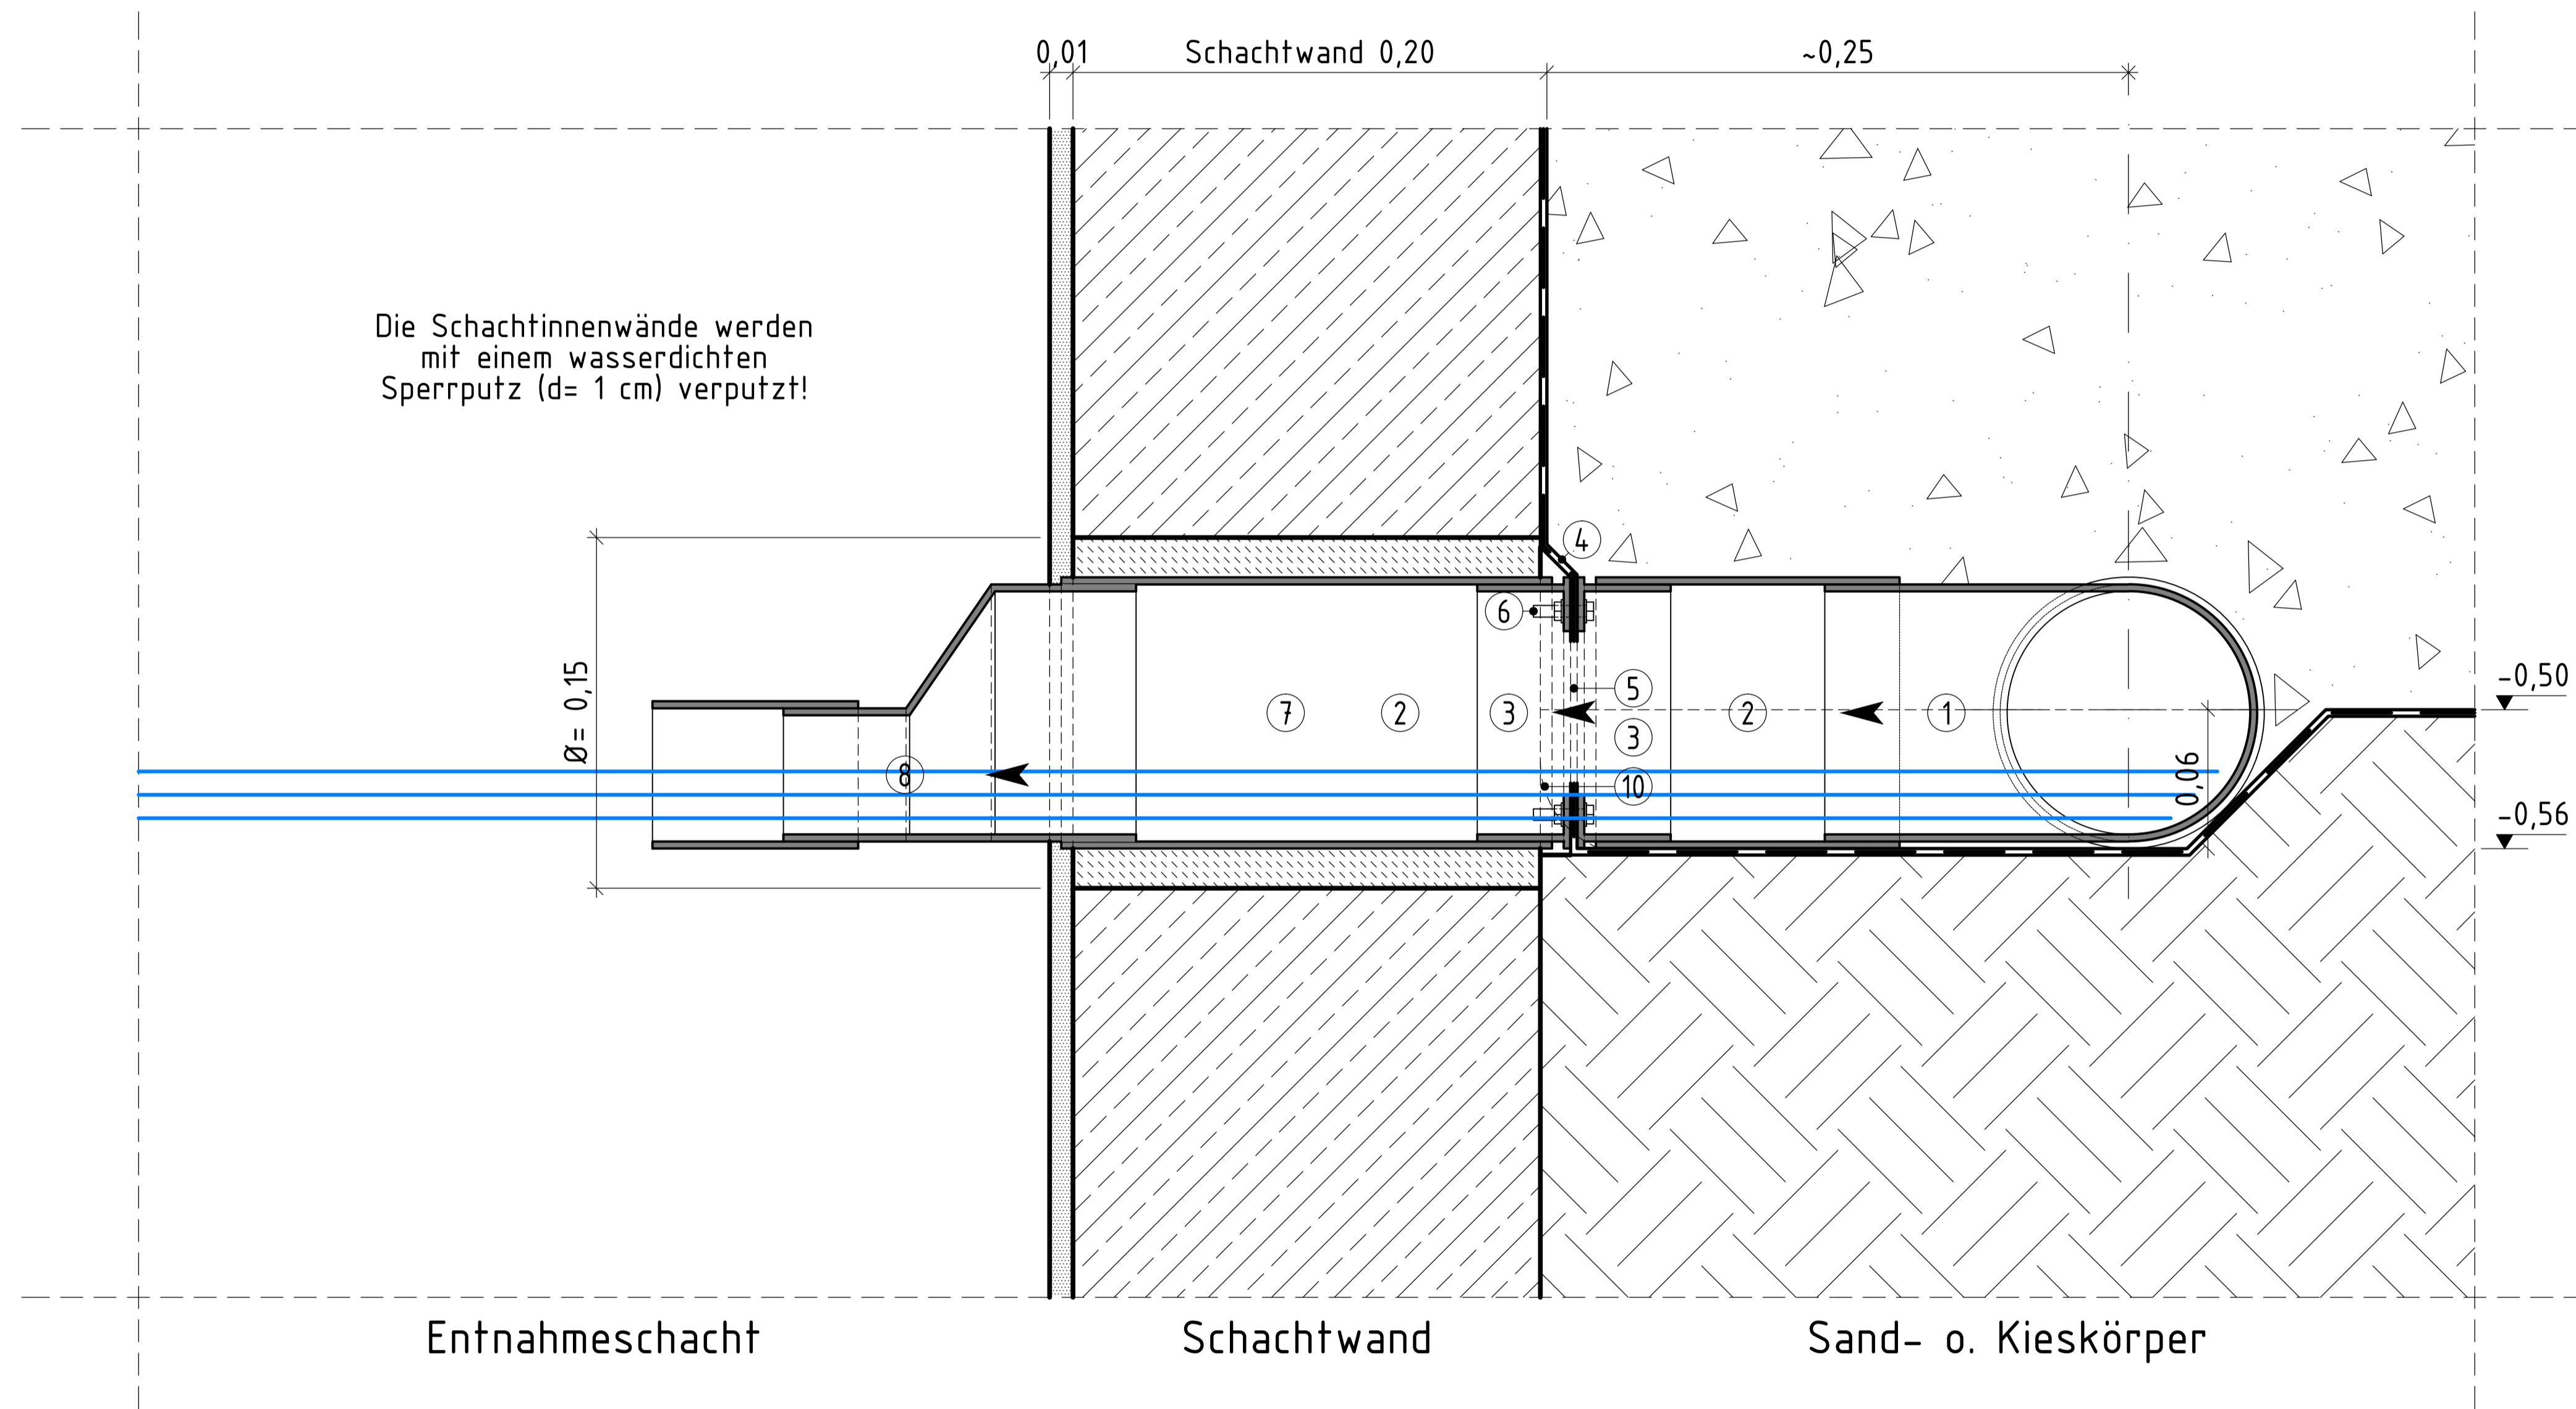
Detail B: Ablauf am Entnahmeschacht Horizontal durchströmte Pflanzenkläranlage (vereinfachte Bau- und Betriebsform)
